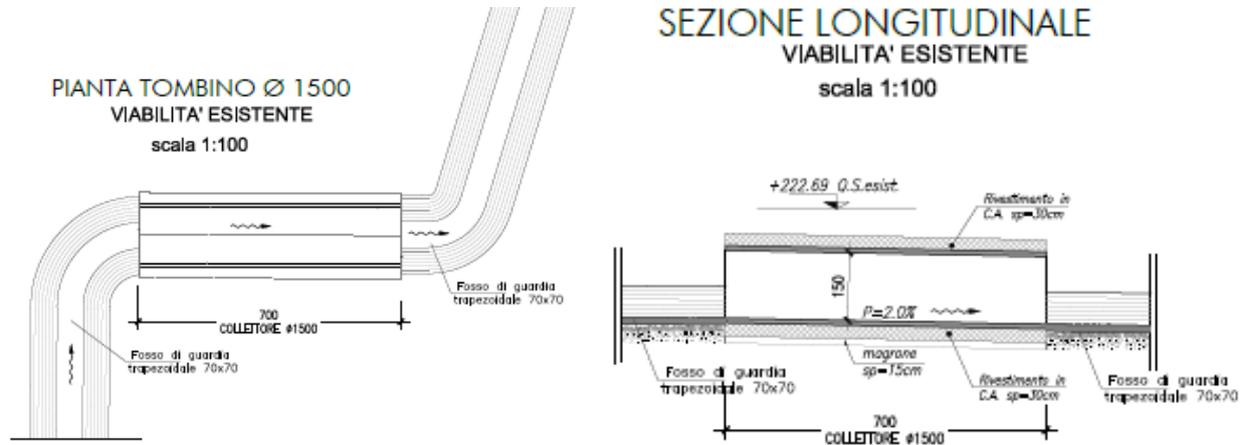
Planimetria e sezione longitudinale tombino sotto viabilità esistente
